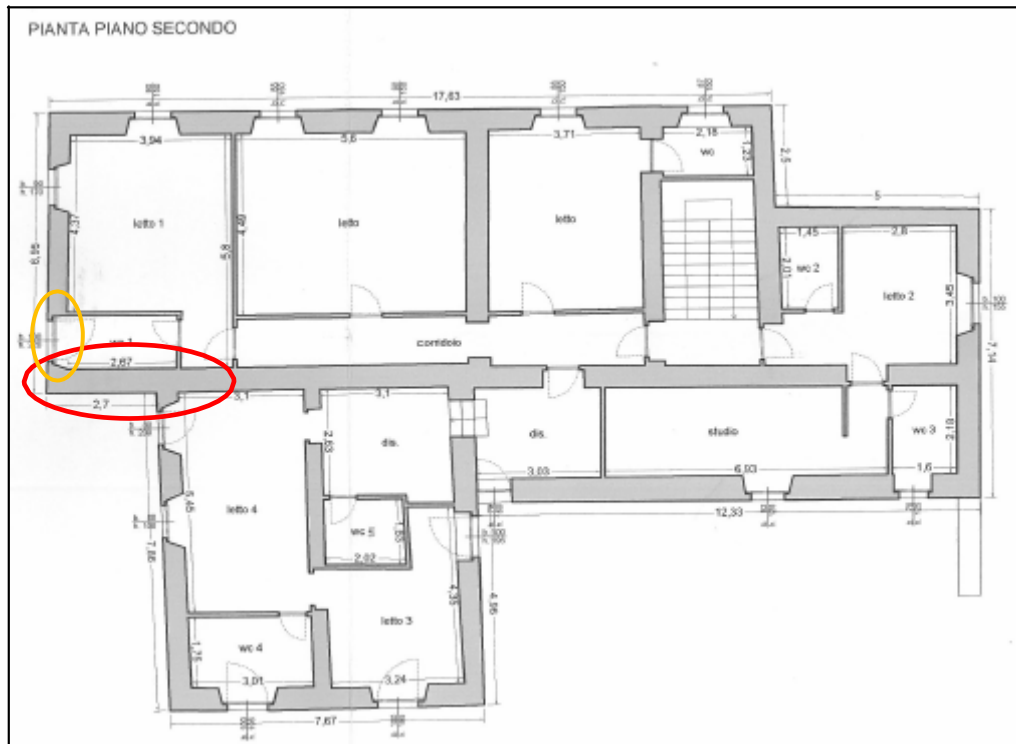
Figura D - Individuazione del maschio murario interessato dalla lesione oggetto di perizia (colore rosso) e dell'apertura causa di indebolimento (colore arancione) – Piano secondo
